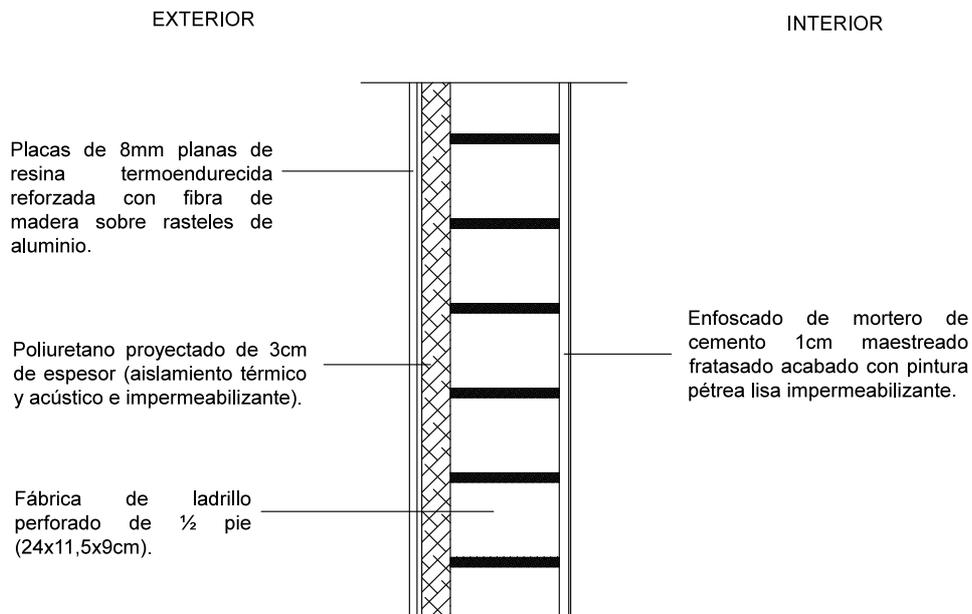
Detalle constructivo cerramiento fábrica de ladrillo.
